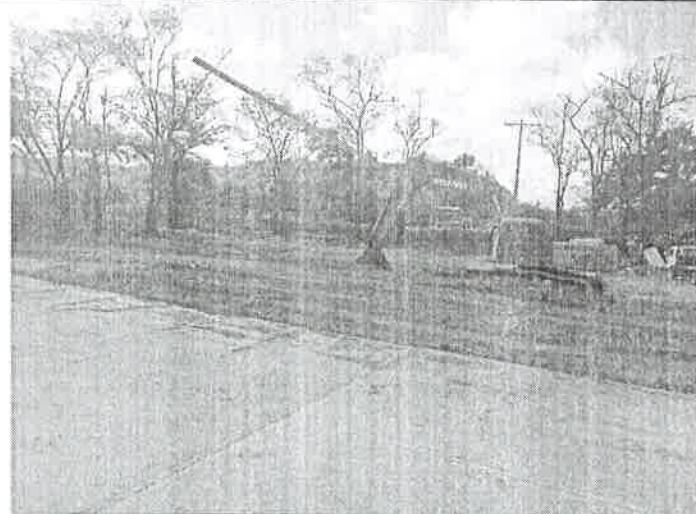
losa de concreto, con la cual se ha pavimentado el suelo.
